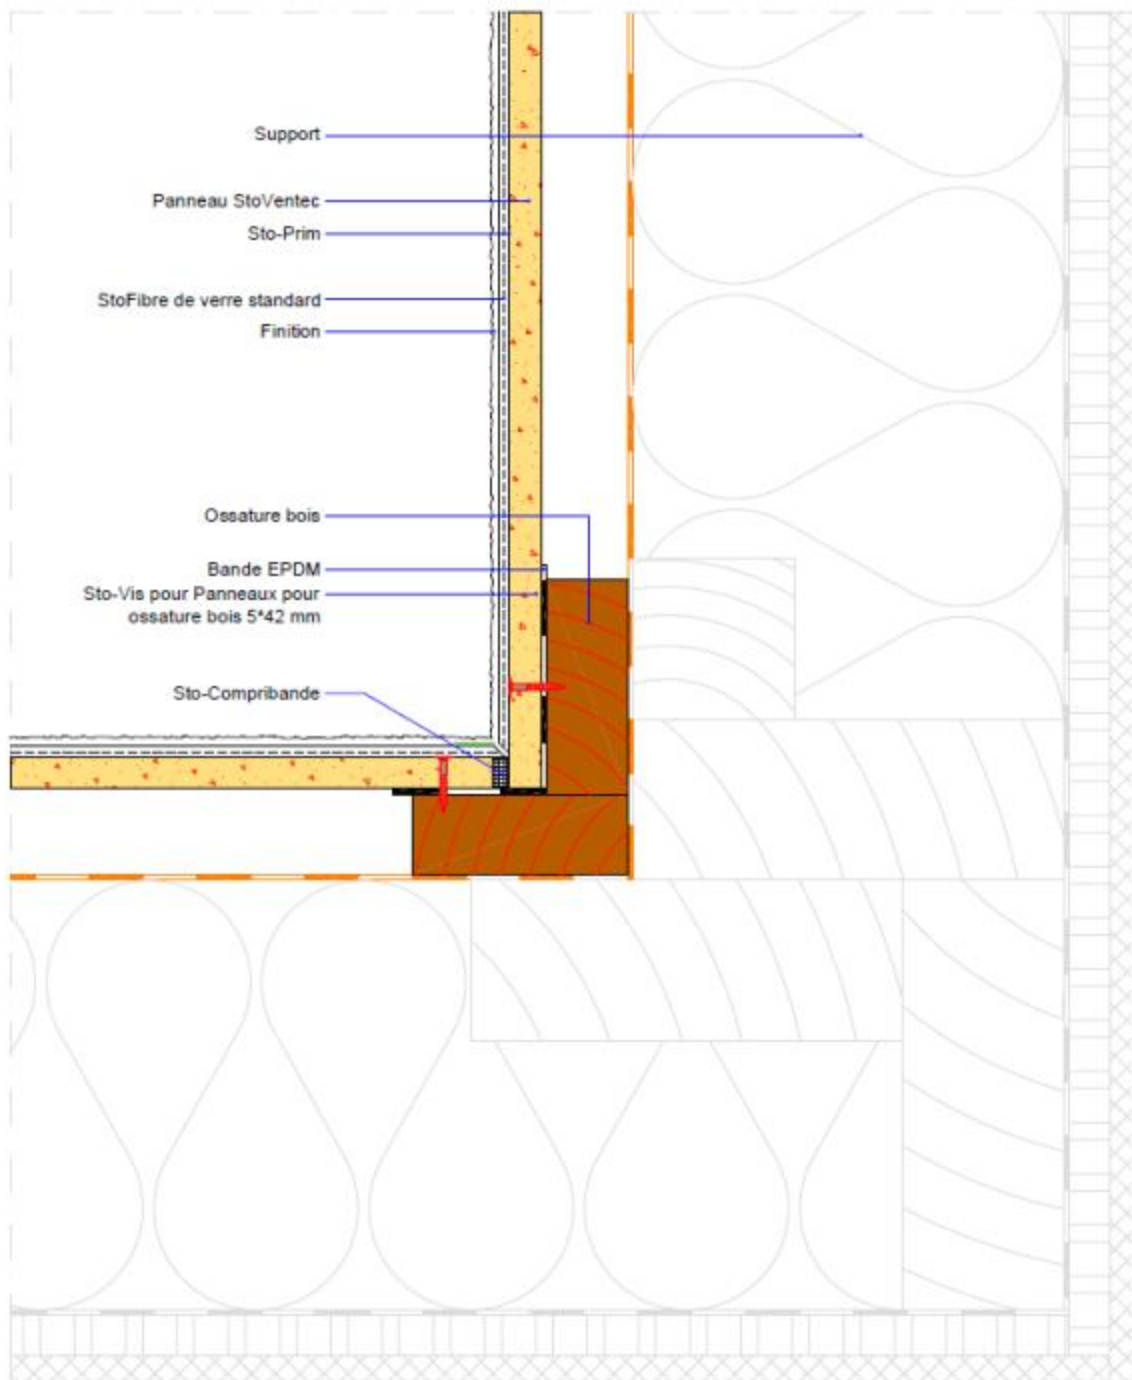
Coupe horizontale - Angle rentrant - Ossatures bois sur support COB
